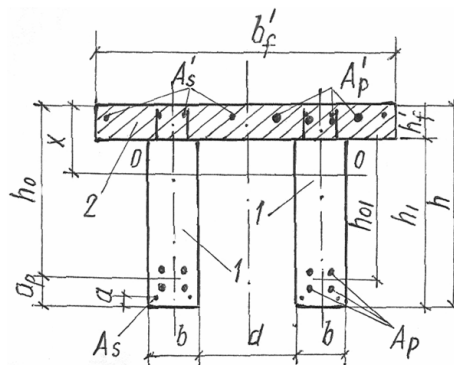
Поперечний переріз збірно-монолітних залізобетонних елементів із двох балок і монолітної плити, що утворюють переріз у формі 2Т
